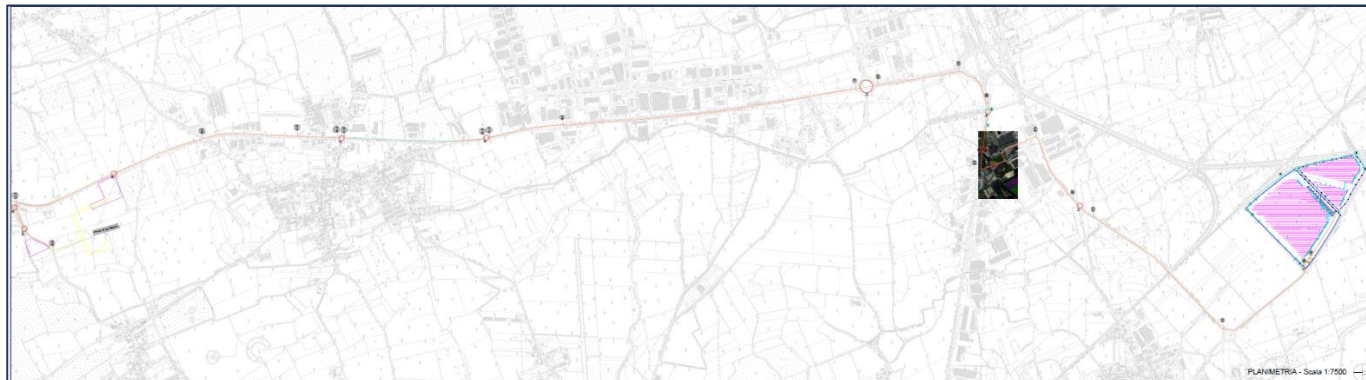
Planimetria generale linea di collegamento cavidotto con interferenze – Pradamano – ST
